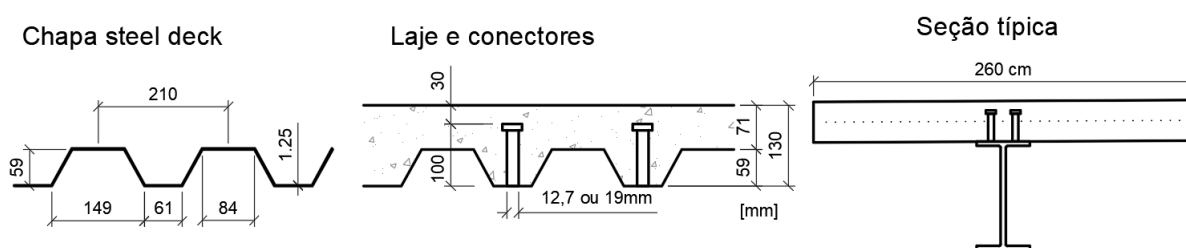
Seções transversais chapa *steel deck*, laje e seção típica perfil
